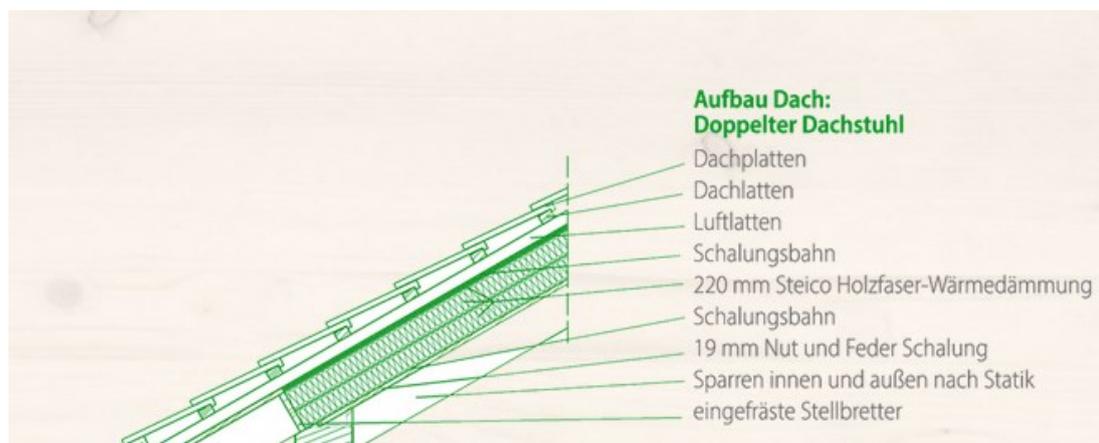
Dachaufbau bei CHRISTA Blockhaus e.K.
